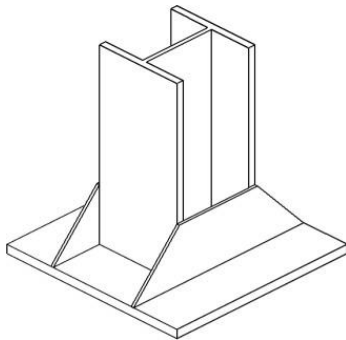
Vista 3D de la placa de anclaje de los pilares de un PÓRTICO TIPO.
